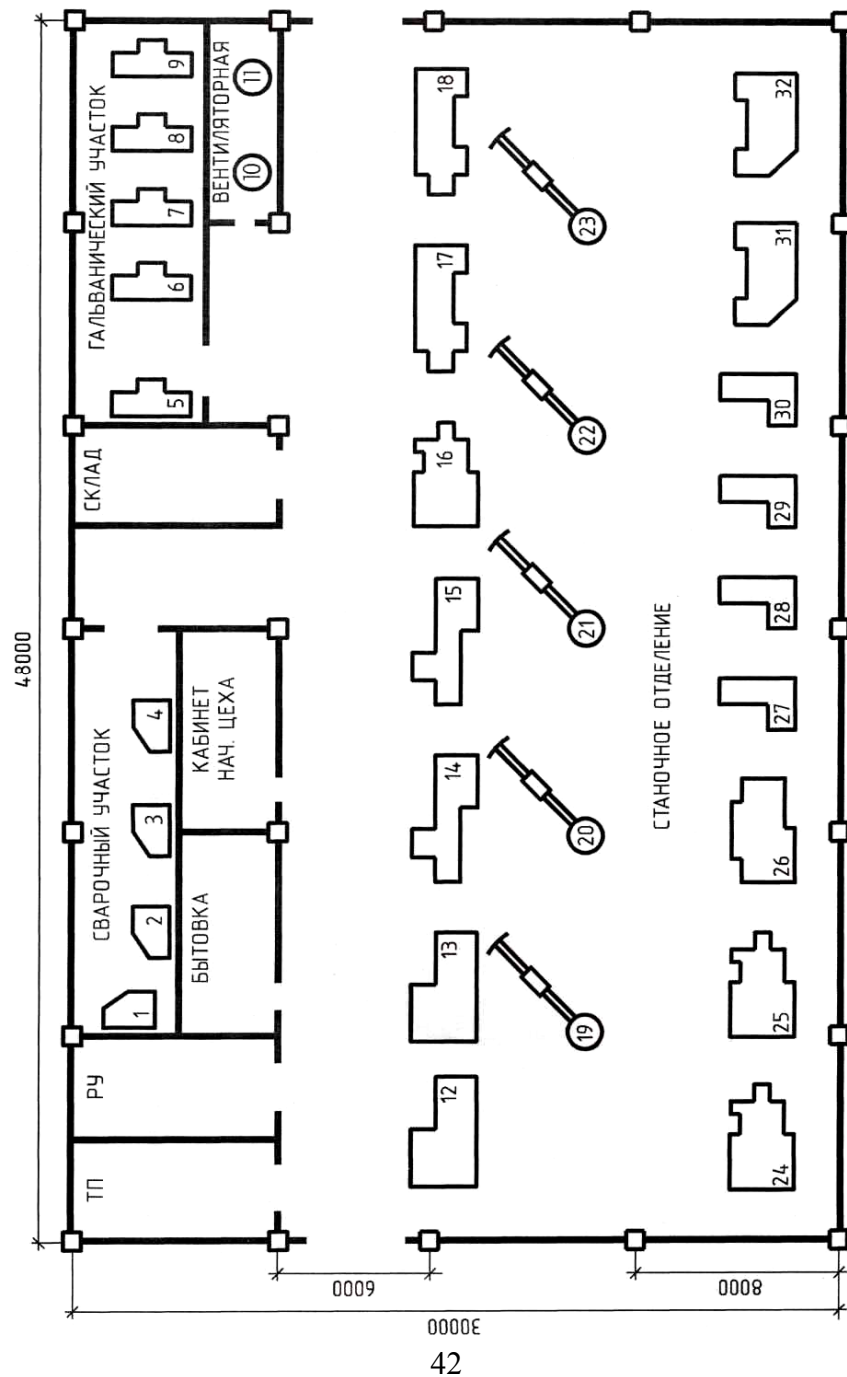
План расположения ЭО цеха обработки корпусных деталей
